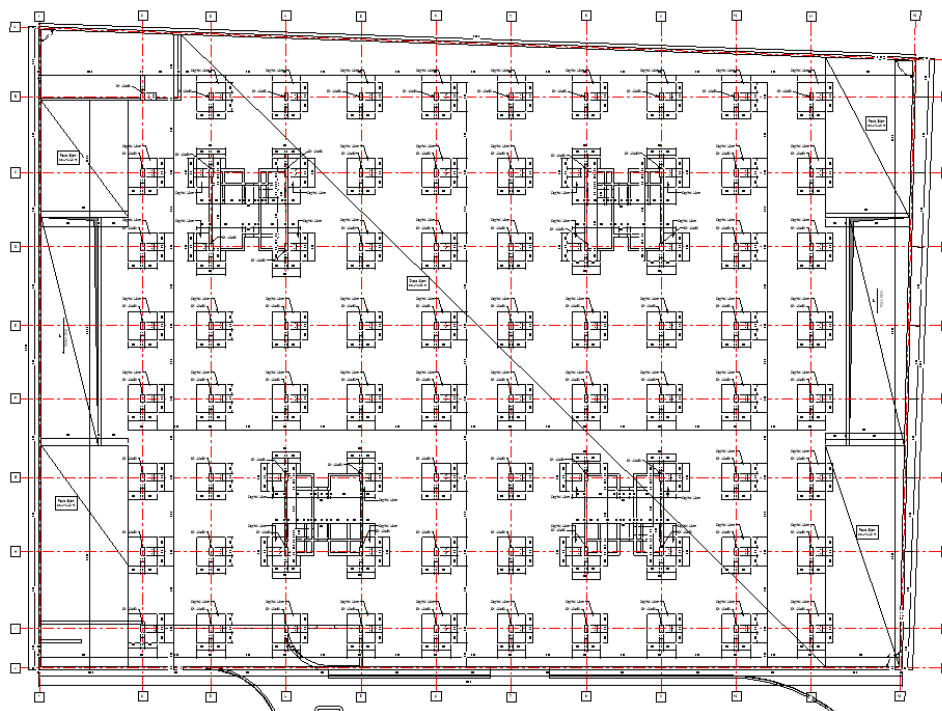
Plan cofraj planșeu peste Subsol 2
